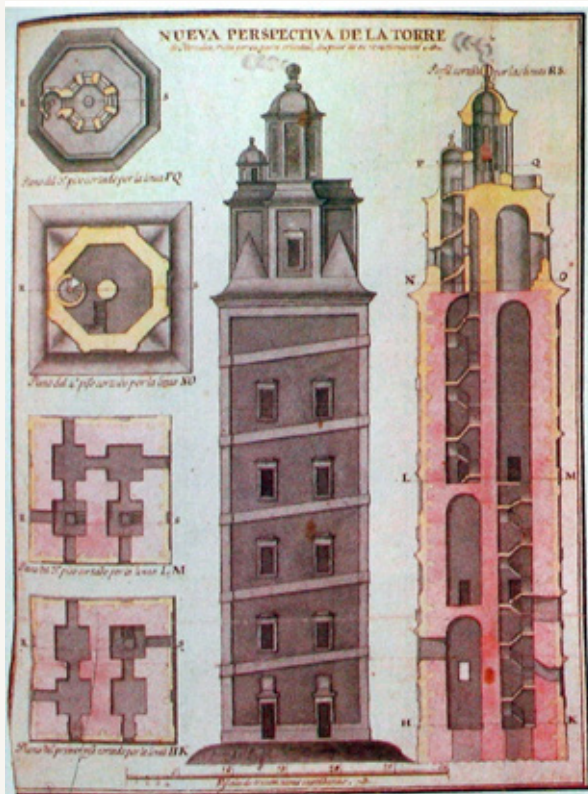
Planimetría de la última reconstrucción de la Torre de Hércules por Giannini.
